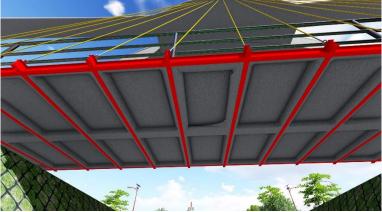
Estructura mixsta de perfíl laminado y hormigon alivianado
